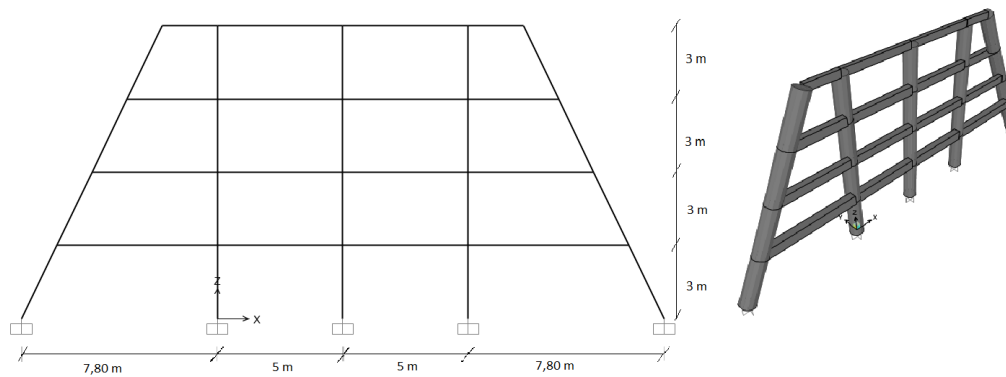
Pórtico Modelo A – 25g, inclinación de columnas 25° respecto al eje vertical.
